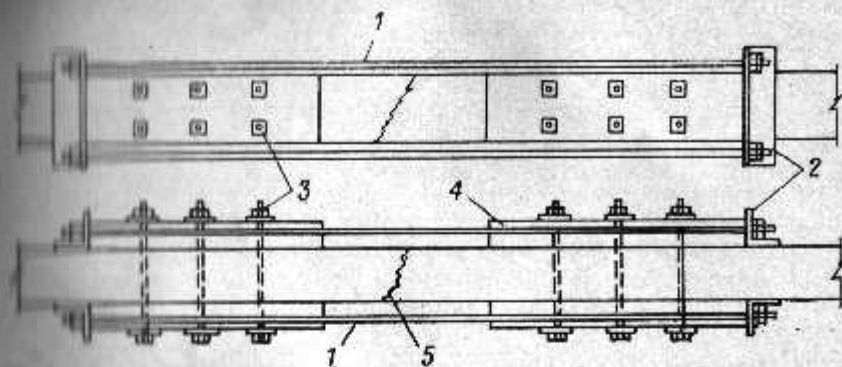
Усиление участка нижнего пояса фермы из брусьев с помощью тяжей (тяги; 1 — уголки; 2 — болты по расчету; 4 — накладки; 5 — место разрыва пояса
